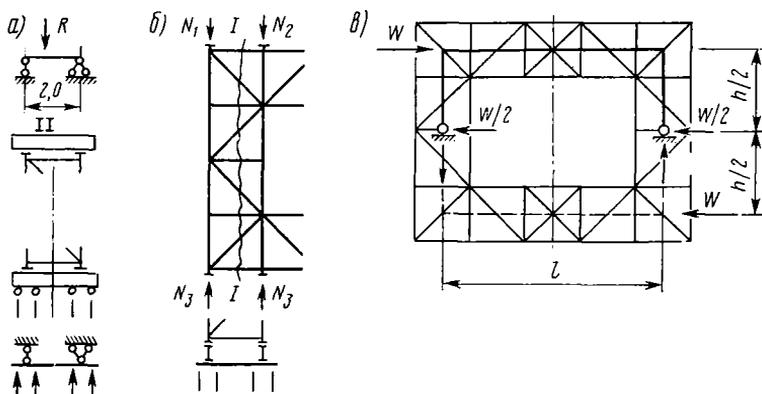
Схемы к определению усилий в элементах решетчатой надстройки
